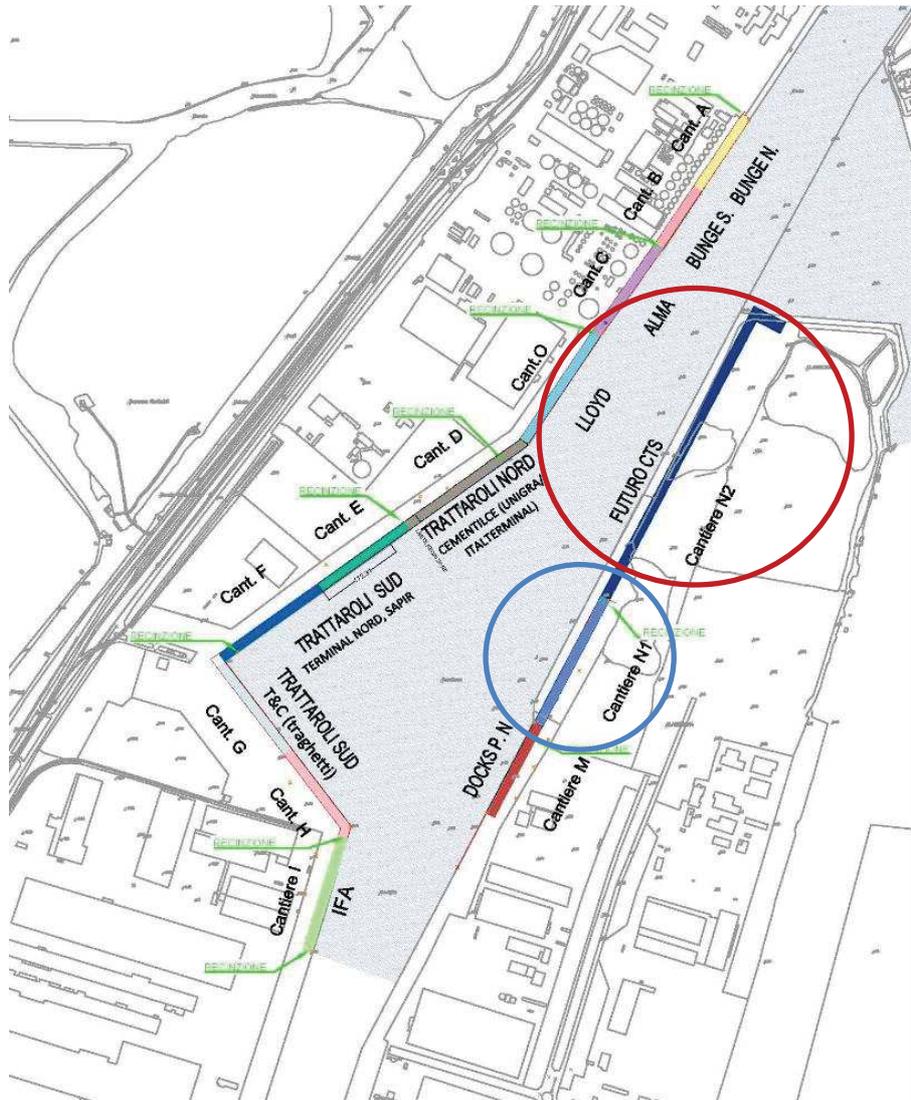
Planimetria di inquadramento con ubicazione delle banchine e relativi cantieri
